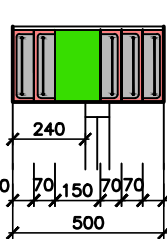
DETAIL ULOŽENÍ PŘEKLADŮ M 1:25
